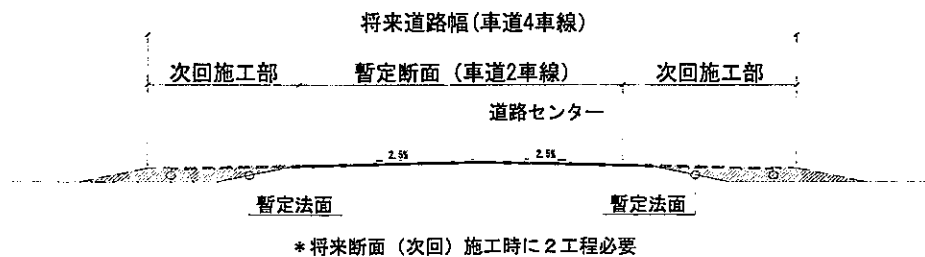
ウズベキスタン道路公社の施工法 (暫定施工時)
